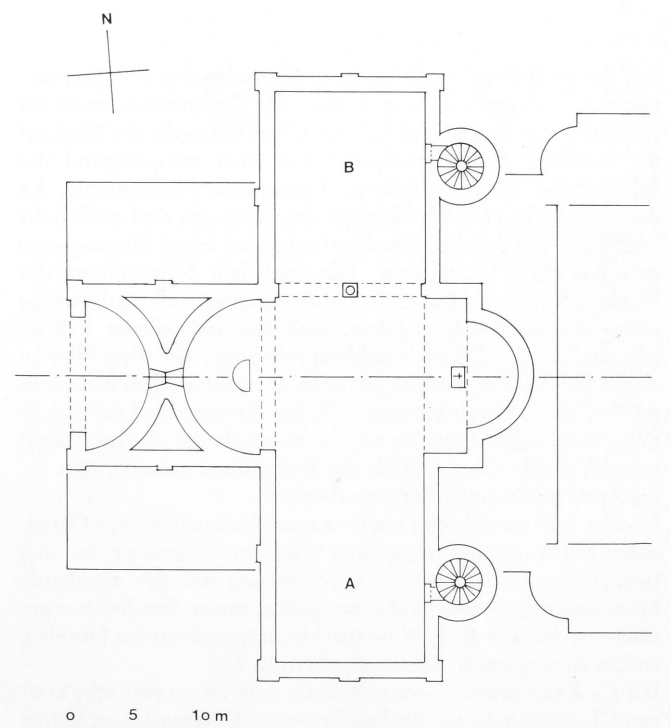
Rekonstruktionsversuche Obergeschoßgrundriß. C. Meckseper.
